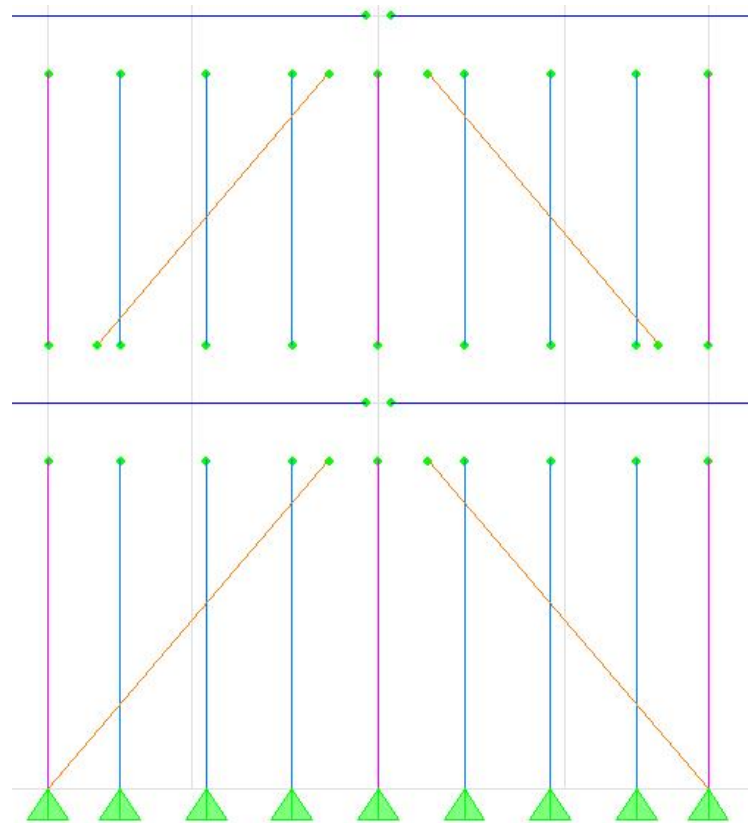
Modelagem de painéis com contraventamentos
